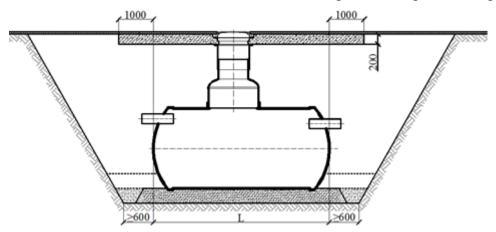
Схема расположения горизонтального корпуса в зоне наезда транспорта с низким уровнем грунтовых вод
